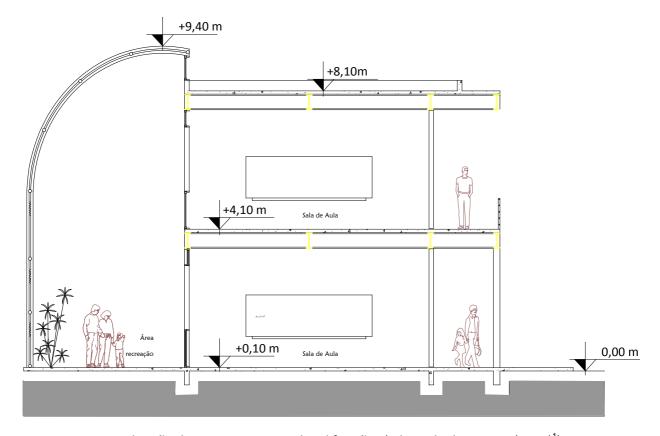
Aplicação de cotas no projeto de edificações (adaptado de KOENIG(2009)¹)
